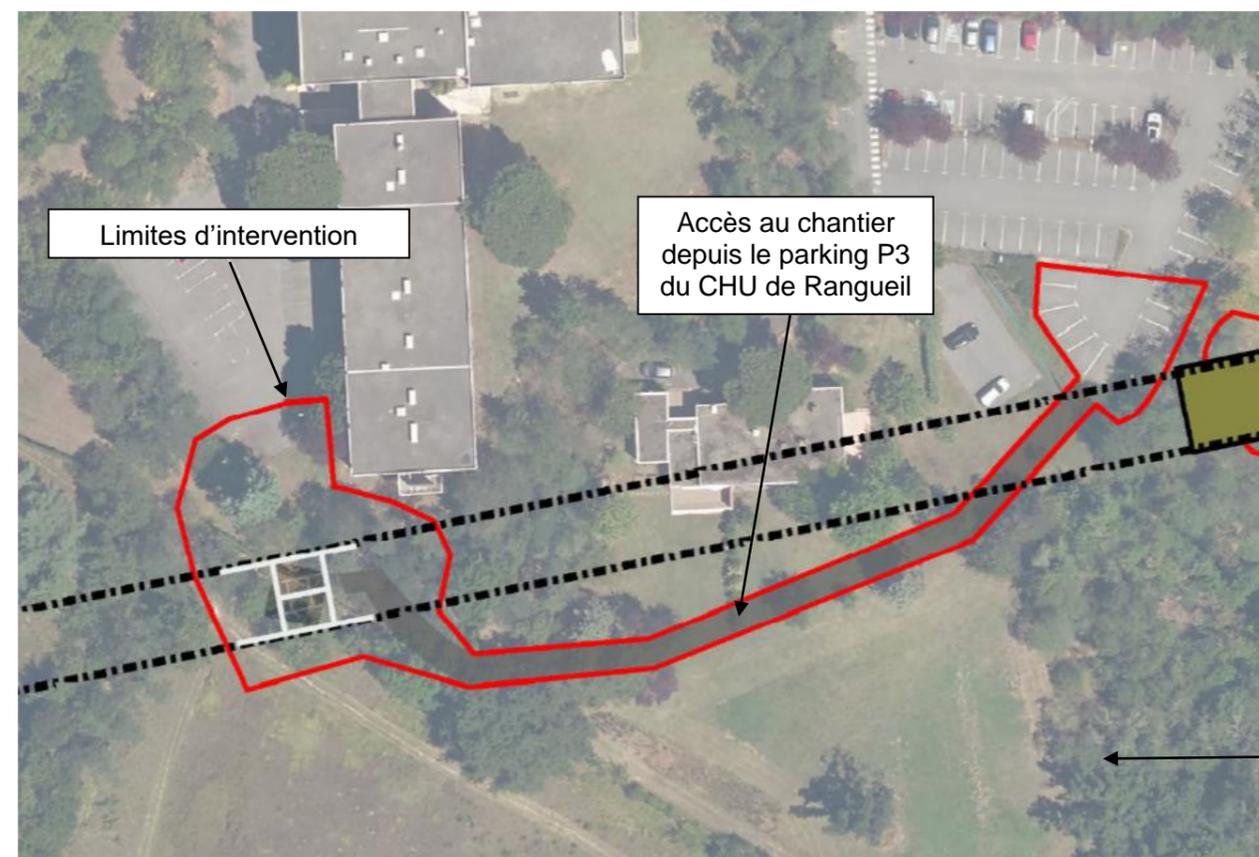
Plan de localisation des travaux de mise en place du P3 (source : Groupement POMA, 2017)
